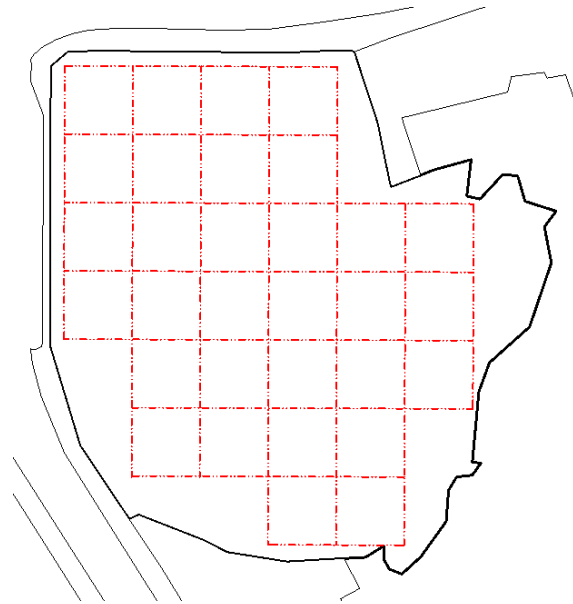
Elaboración propia. Rejilla estructural del edificio.
